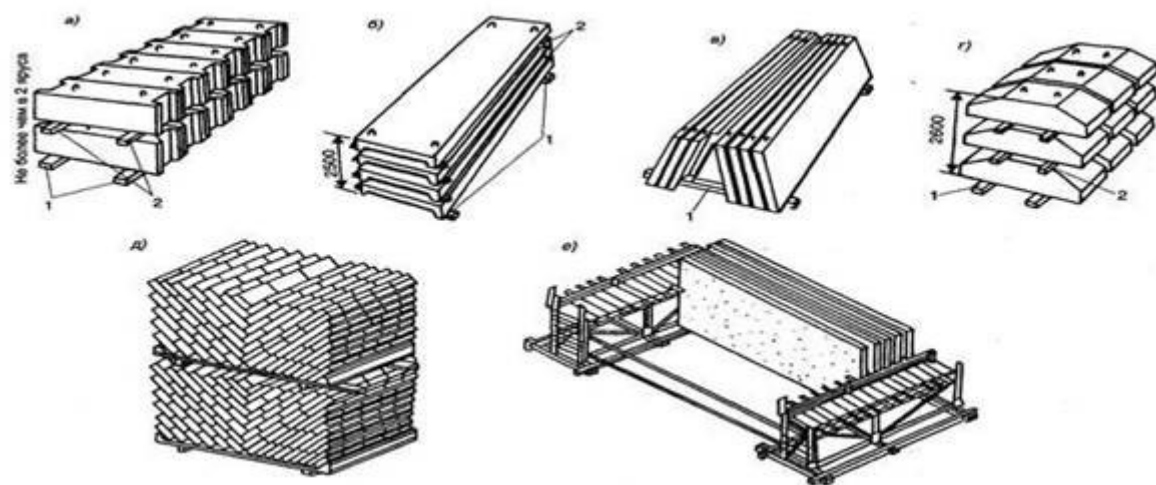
Схема складирования кирпича на поддонах и железобетонных блоков:
